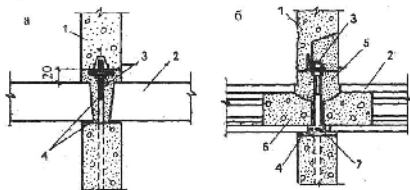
Платформенный стык фиксатора: а - с панелями перекрытий сплошного сечения; б - с многоярусными настилами; 1 - панель стены; 2 - панель перекрытия; 3 - фиксатор; 4 - цементный раствор (или паста); 5 - бетон замолочивания; 6 - бетонные пробки в пустотах панели перекрытия; 7 - стык арматурных выпусков перекрытия
